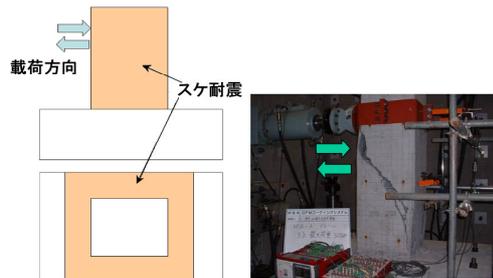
・写真-9 載荷方法とスケ耐震の施工範囲
